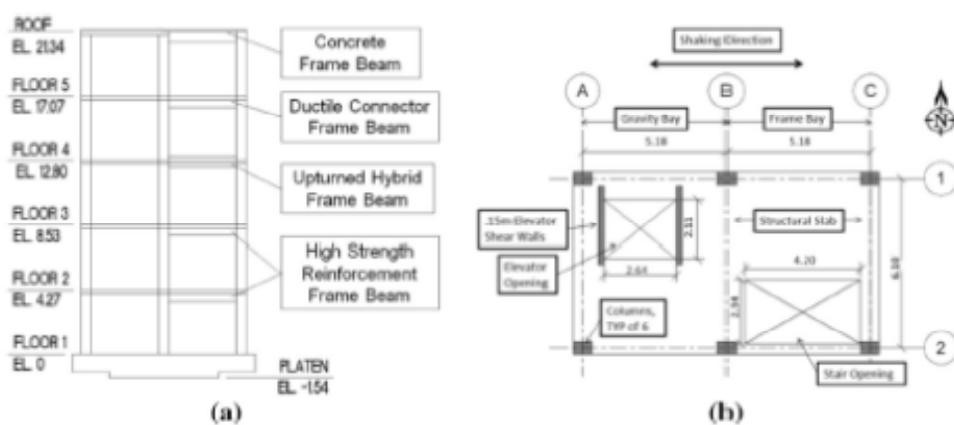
鋼筋混凝土實驗屋樓層及平面配置(參考書目[26])
